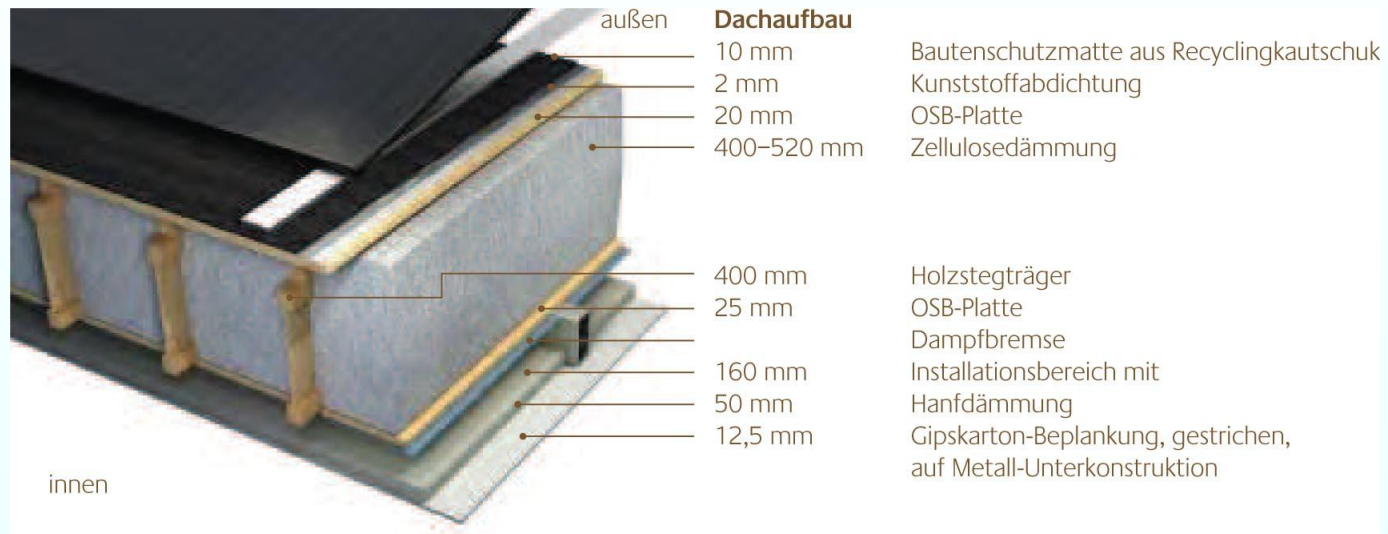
Aufbau Dach über Wohnbereich (gedämmt)
